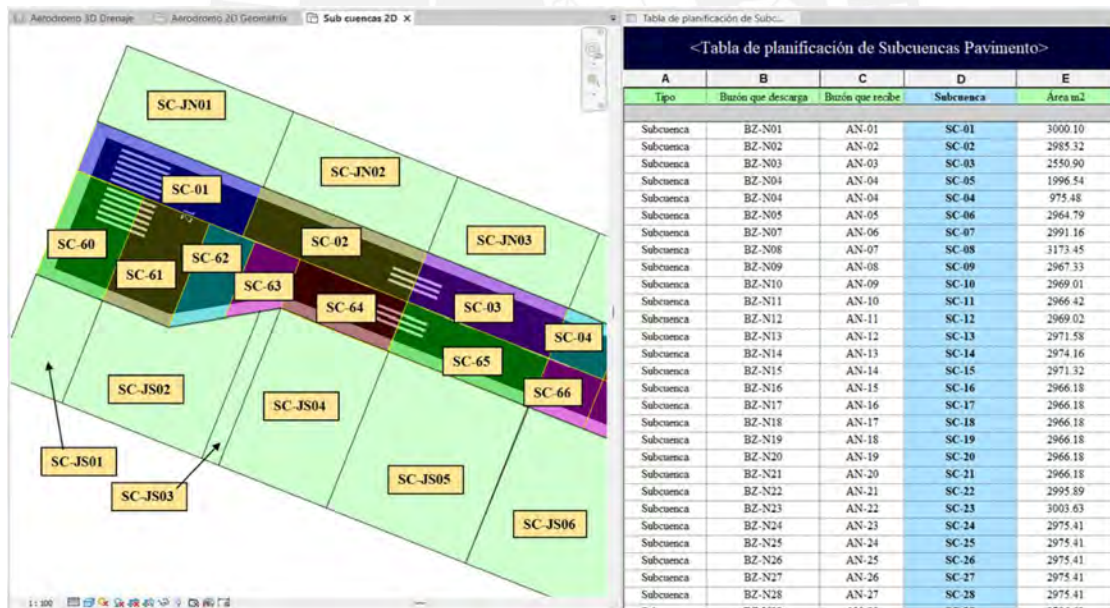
División de áreas de aporte para un lado del área pavimentada.
